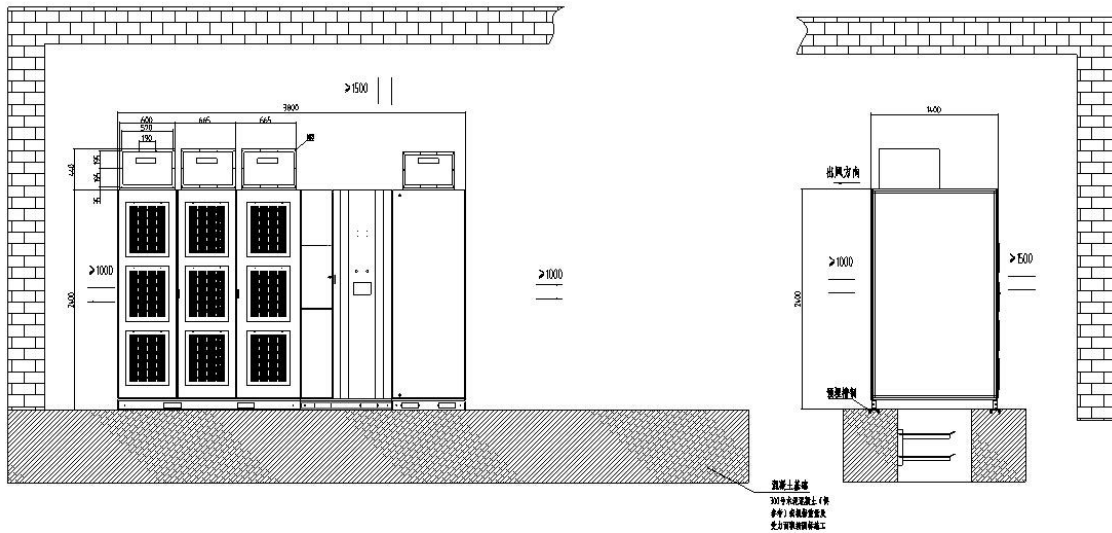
ZBSVG-C4.0/10 安装地基图 Figure 7.3 The installation drawing of ZBSVG-C4.0/10
